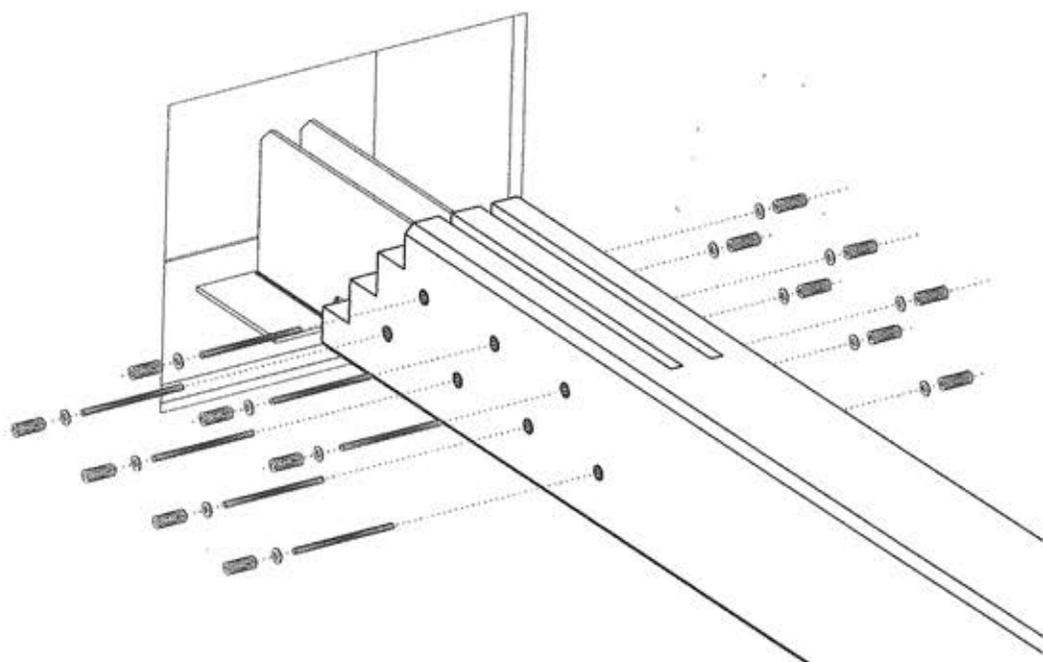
c – Ricostruzione dell'appoggio della trave con protesi costituita da profilati piatti d'acciaio. Fase 3: perforazione dell'insieme legno-acciaio e inserimento di barre filettate o bulloni collegati con dadi "a scomparsa" e delle resine epossidiche.
